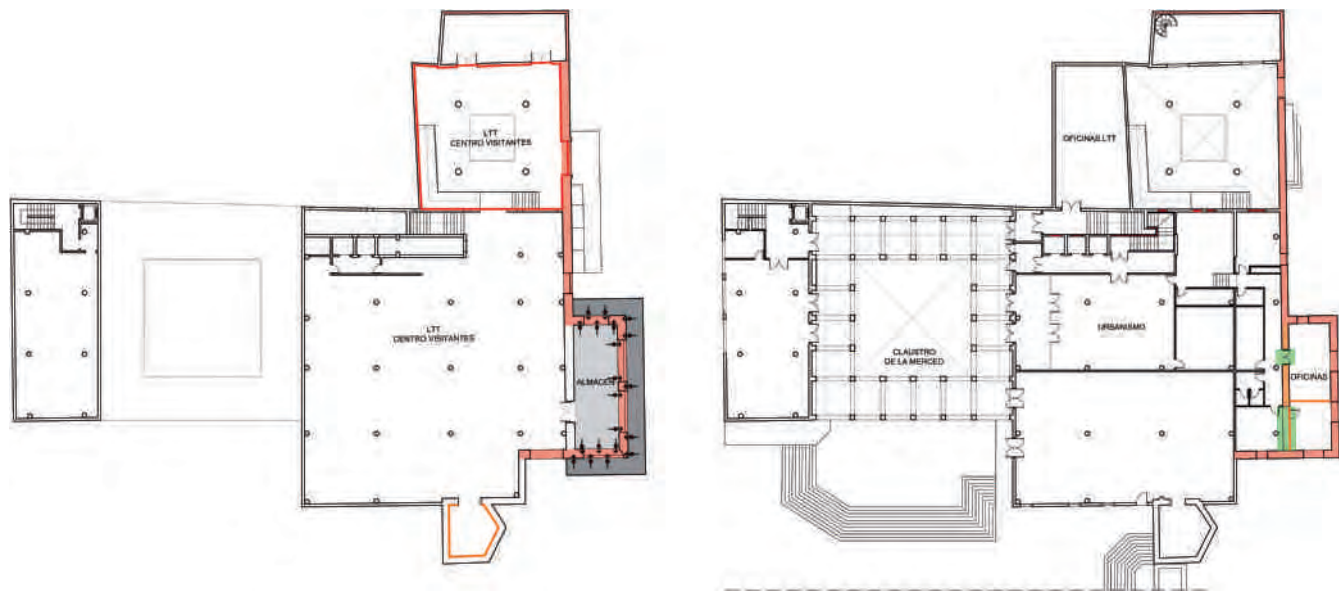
Sótano y planta baja del complejo de La Merced indicando las áreas a intervenir.
